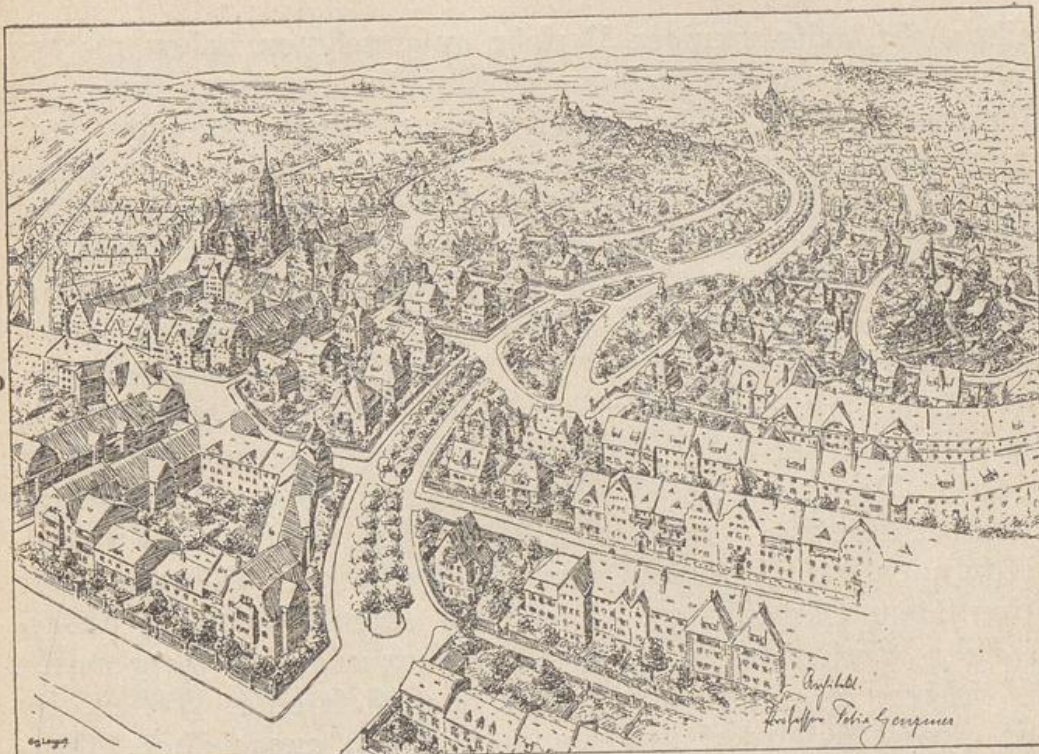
Bebauungsplan für das Fischerberg-Gelände der Stadt Hirschberg i. Schl., Schaubild und Lageplan.
